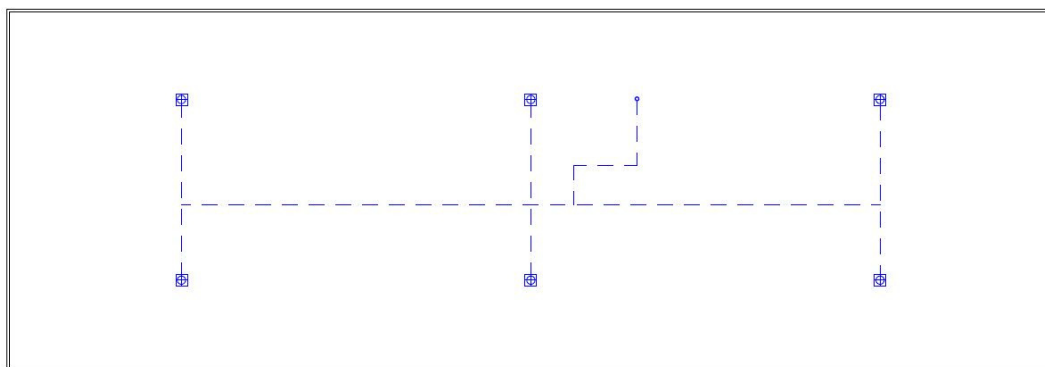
Planta da rede de drenagem de águas pluviais da cobertura
